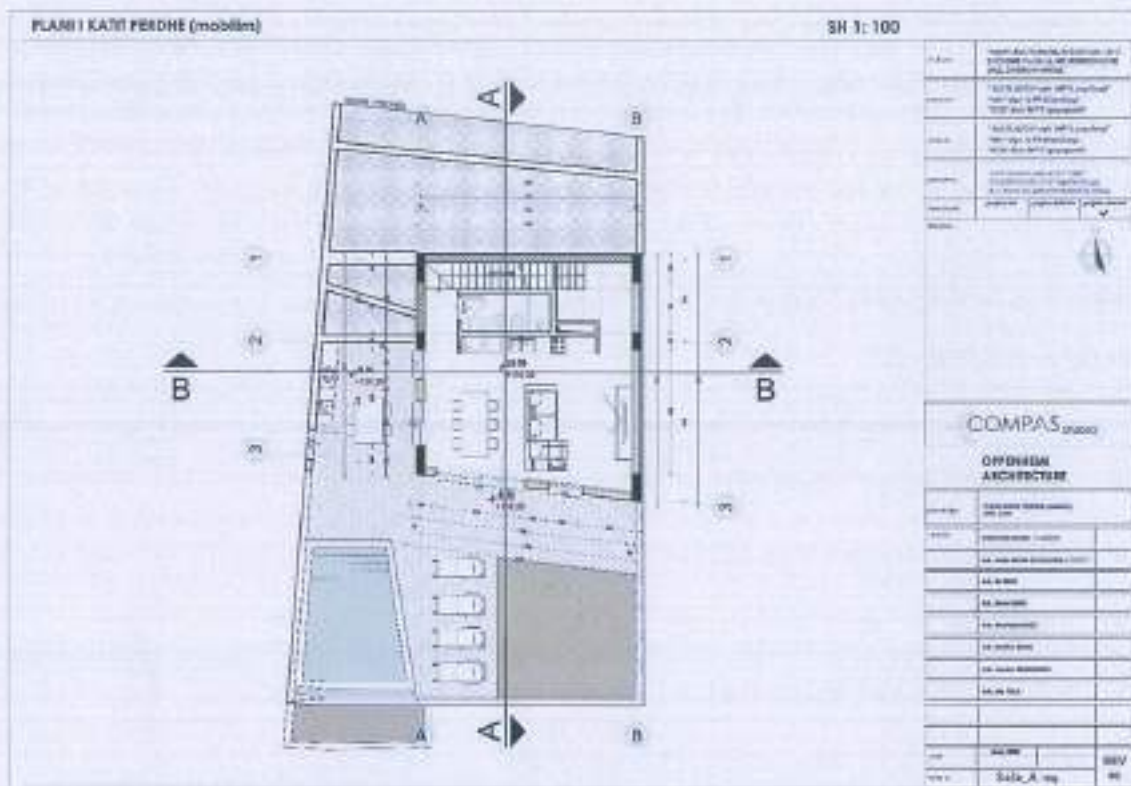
Vila S3/a \_Planimetria e katit përdhe
